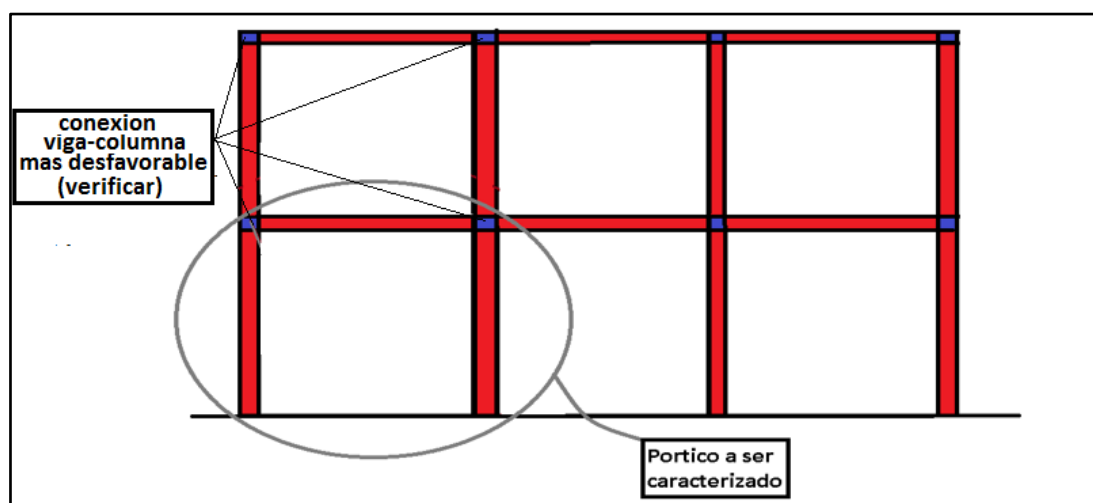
Idealización de pórtico perimetral de esquina a ser caracterizado.
